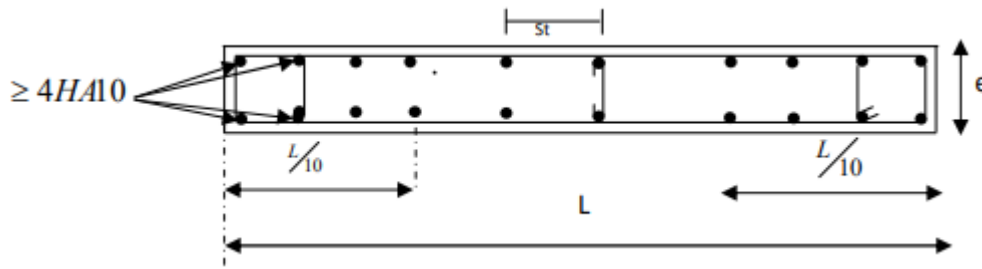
Disposition des armatures verticales dans les voiles.
